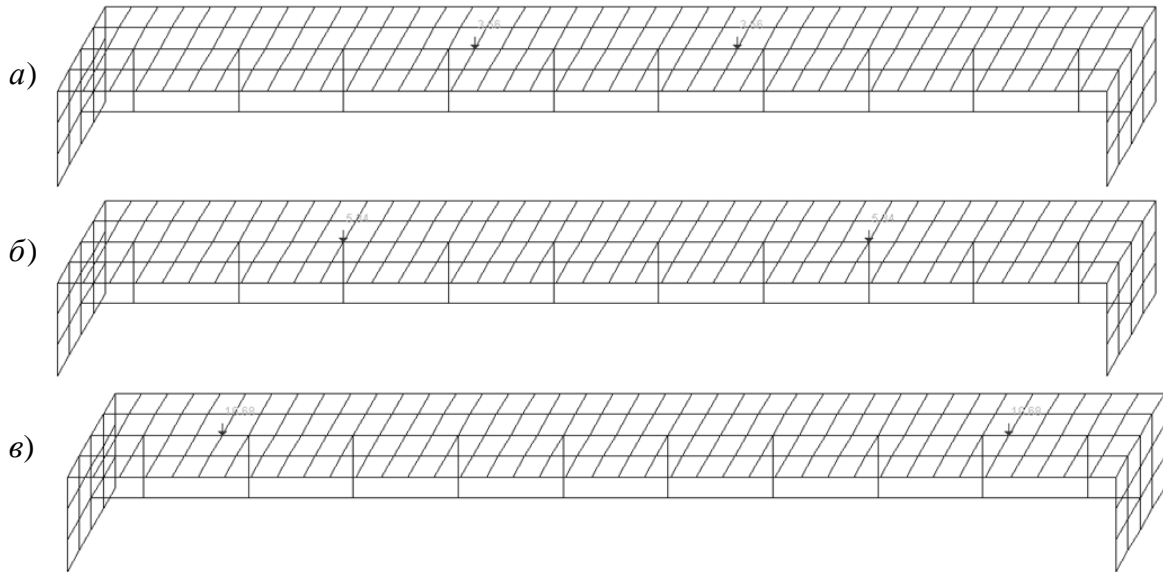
Розрахункові схеми балок з прикладеним навантаженням:
